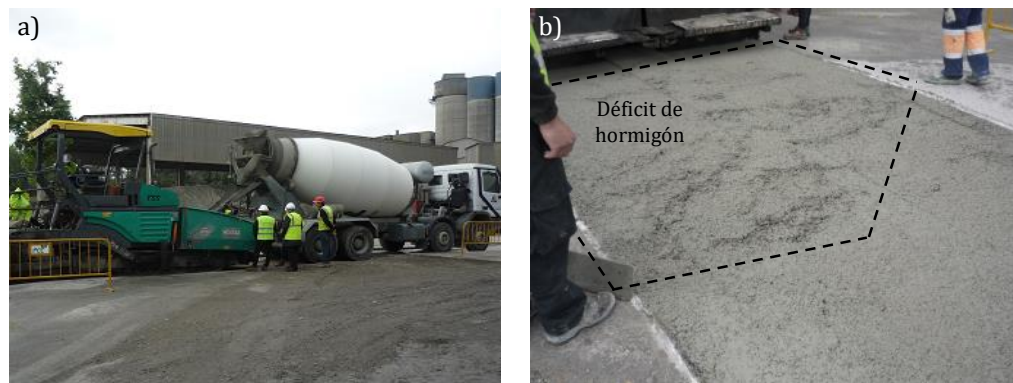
Vertido del hormigón sobre la extendidora (a). Defecto superficial debido al déficit de hormigón (b).
